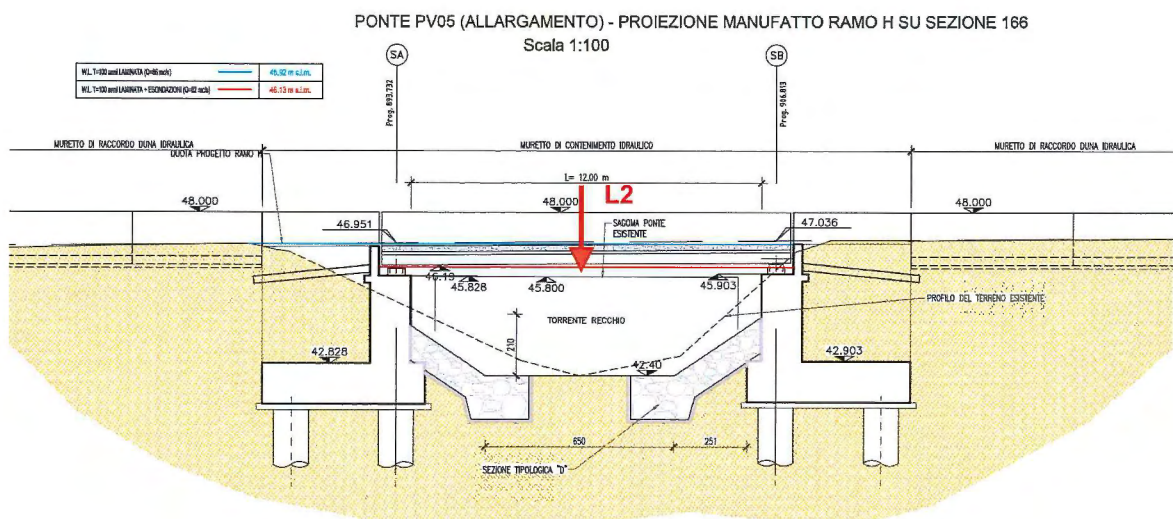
sezione di installazione del nuovo idrometro "L2-Recchio ponte A1"
